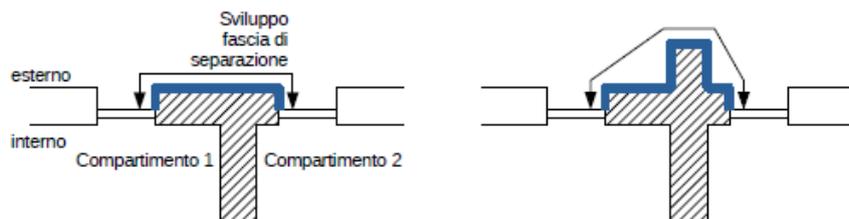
Fascia di separazione verticale, sezione orizzontale
